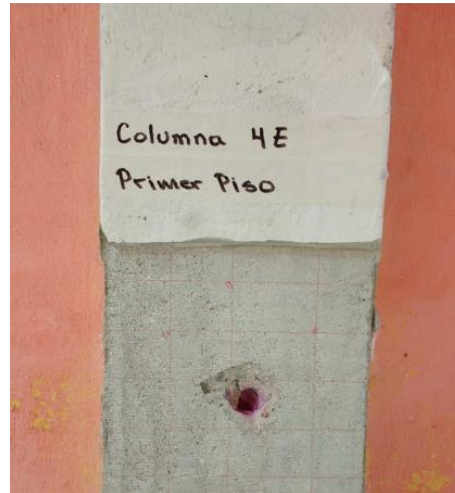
Marcaje de los elementos estructurales en campo para la realización de la exploración.
